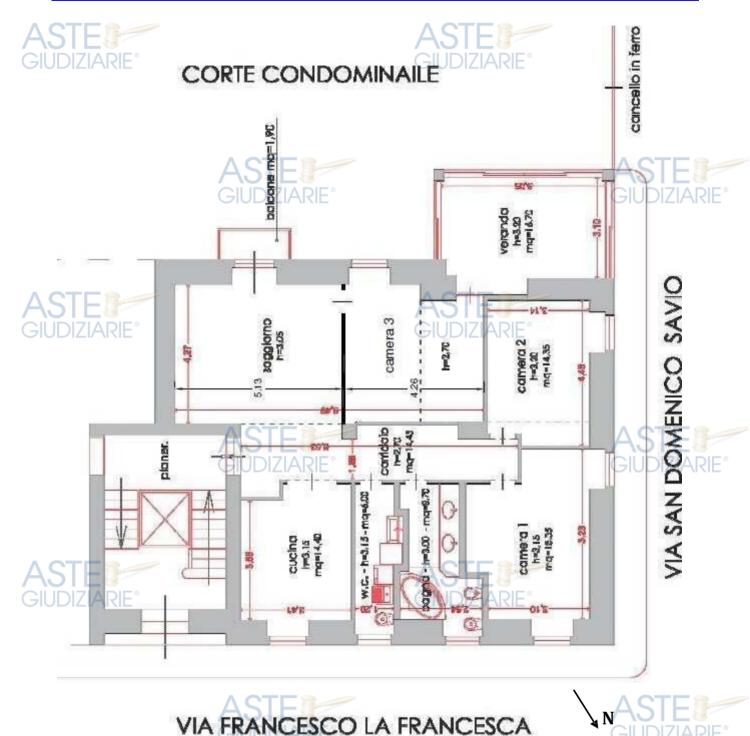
Pianta del piano rialzato (LOTTO unico - Fg. 61, p.lla 204, sub. 12)
